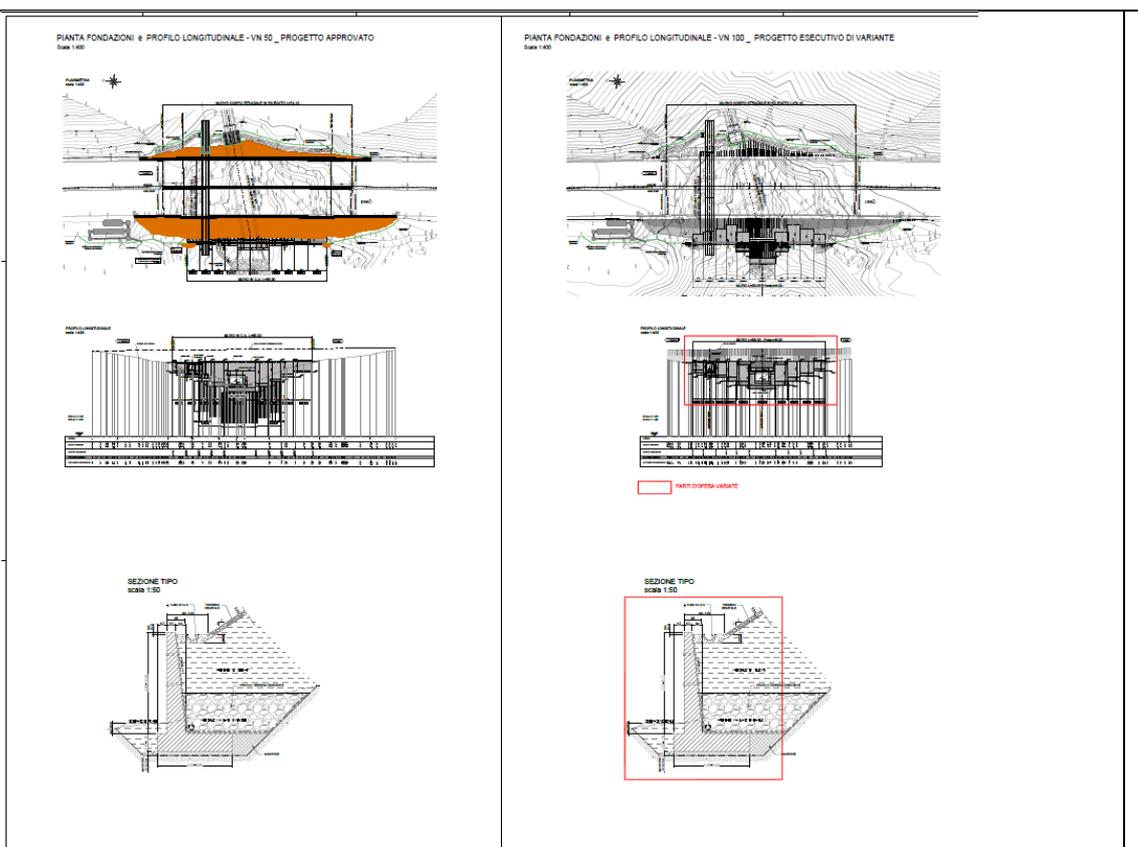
Confronto tra le parti di opera variate con Vn 100 rispetto alla Vn 50 – Viadotto Piletta – Planimetria, Profilo longitudinale e sezione tipo
